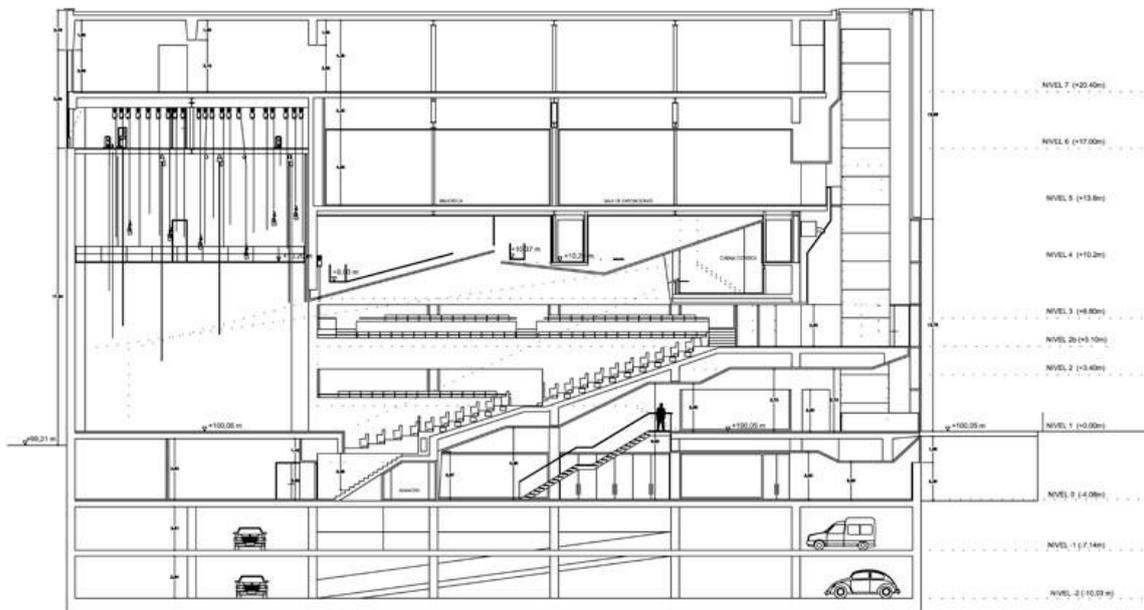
Plano de sección (Gradolí-Sanz Arquitectos)
